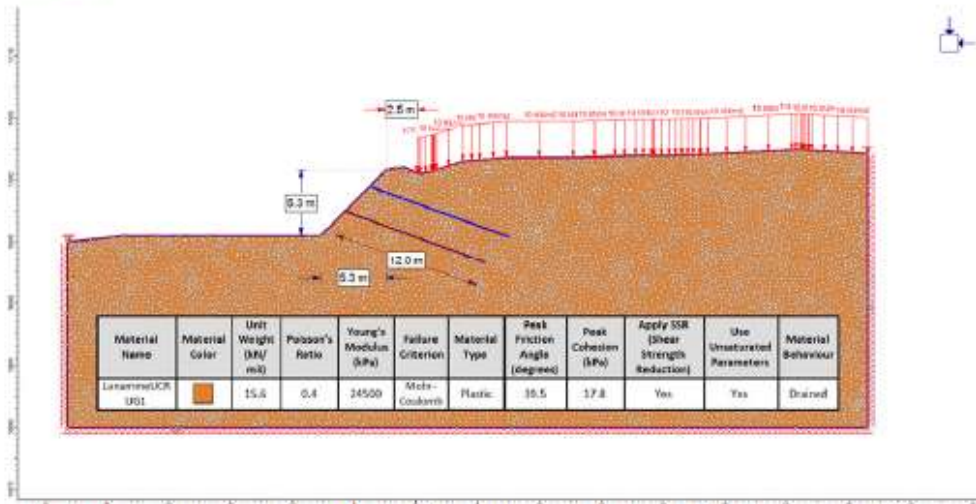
Sección transversal con inclinación de 45° y propiedades geotécnicas de la estación 1+200.
